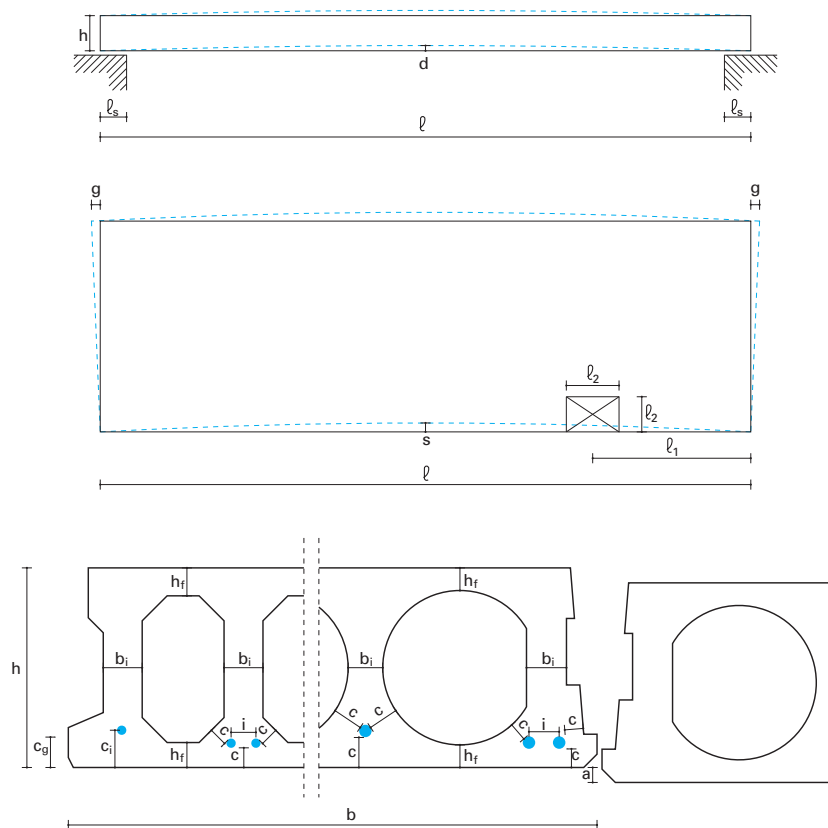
Riferimenti geometrici per le tolleranze dimensionali e di montaggio.
